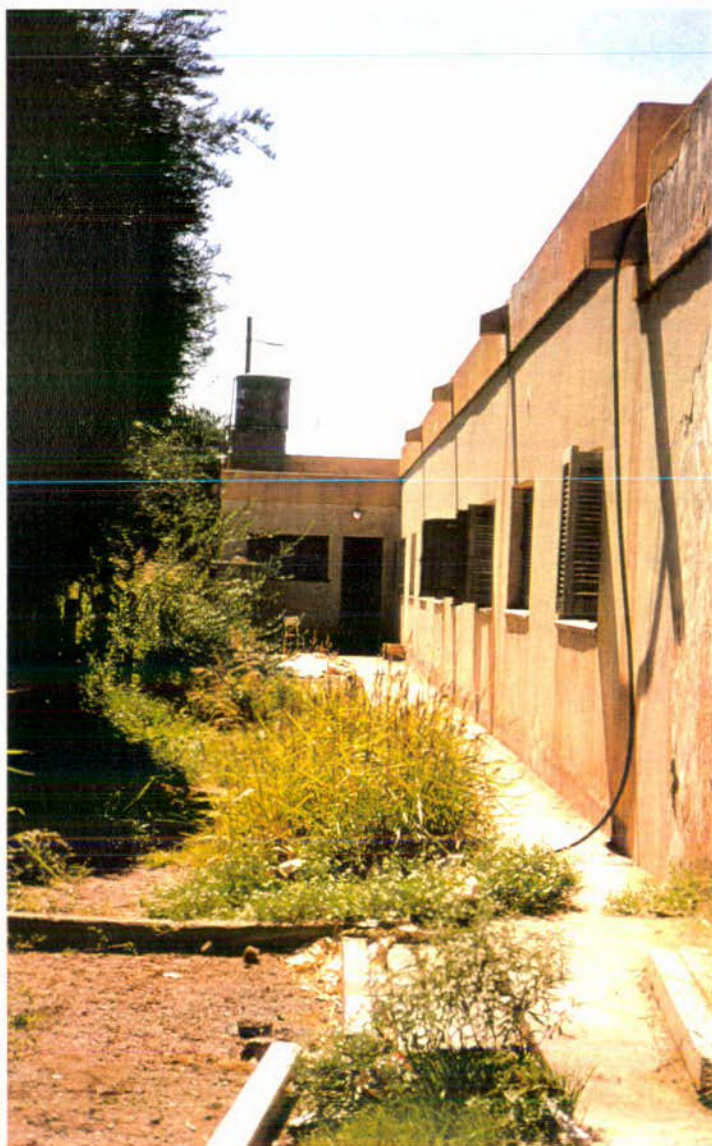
Edificio del Jardín de Infantes que está ubicado a un costado del de primaria y fue concretado con fondos del Plan Social Educativo. Está construido con bloques y tiene techos de chapa con pendiente.
